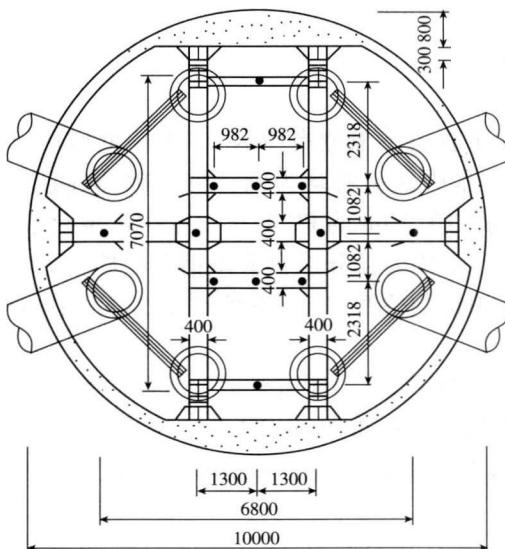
钢扁担梁平面布置(尺寸单位:mm)
